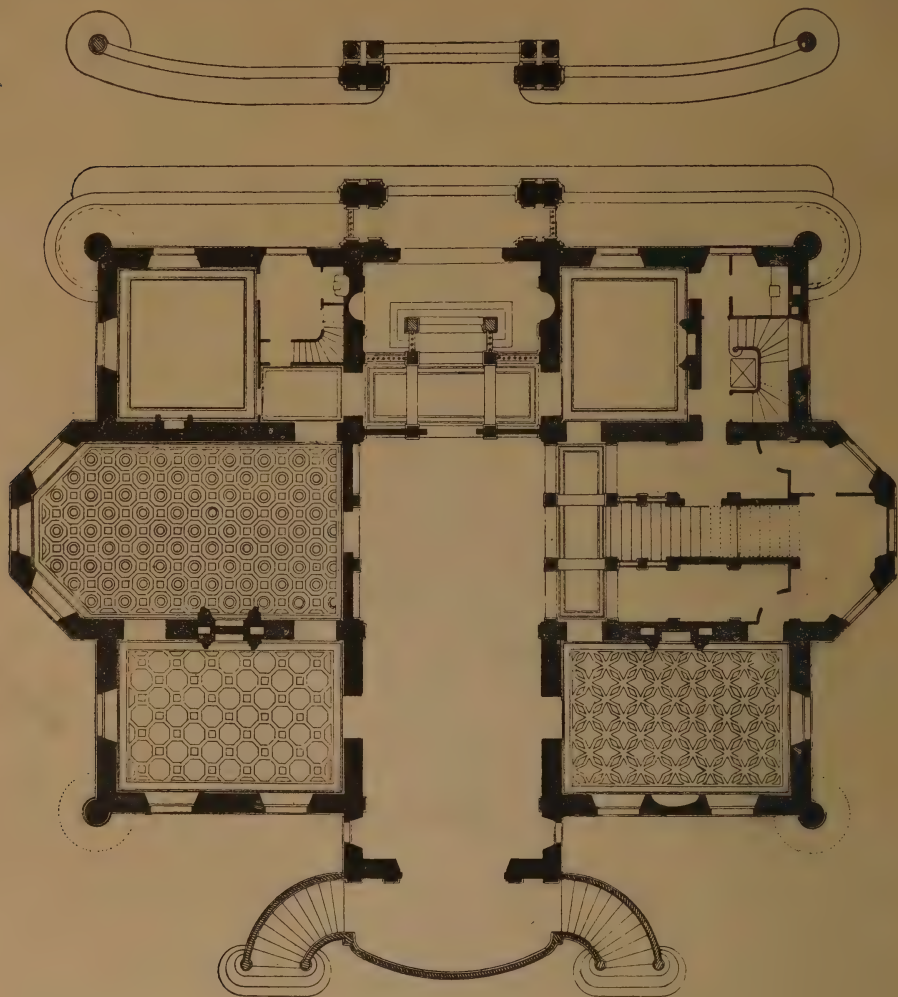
Plan du château de Bon-Hôtel : rez-de-chaussée.
